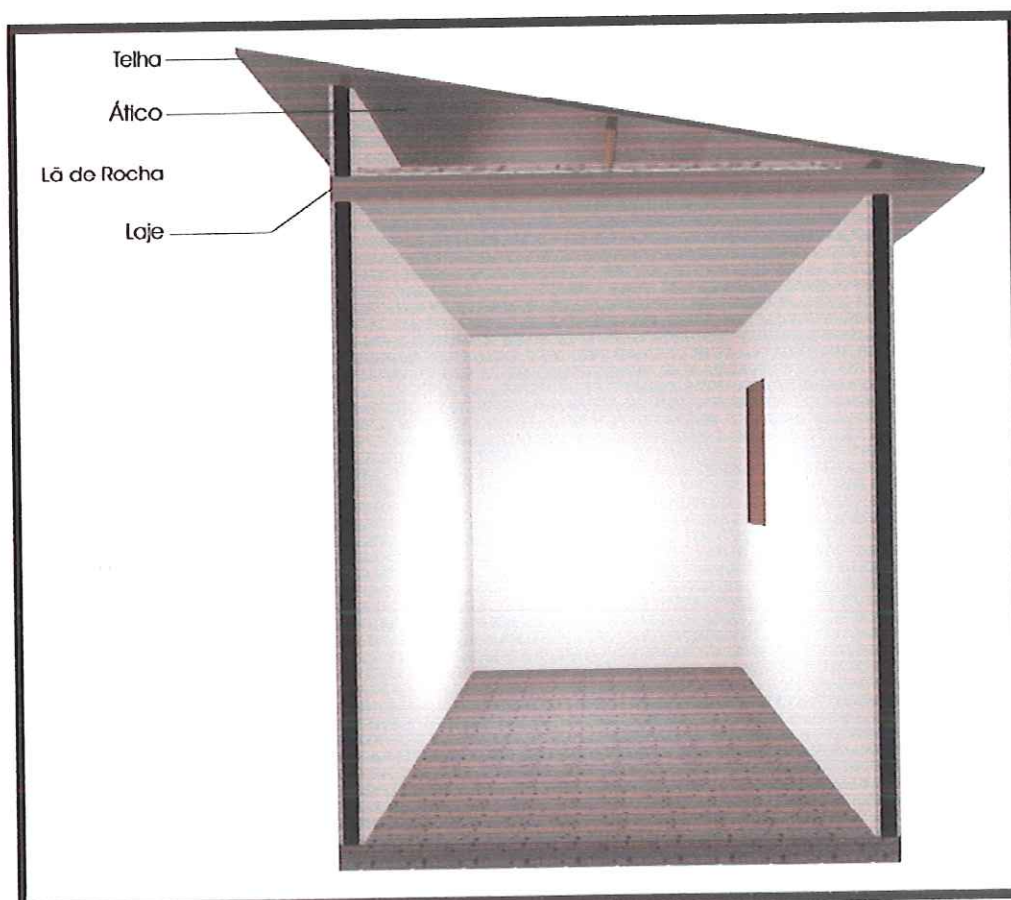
colocação da lã de rocha sobre a laje cerâmica, dentro do ático do protótipo 04
